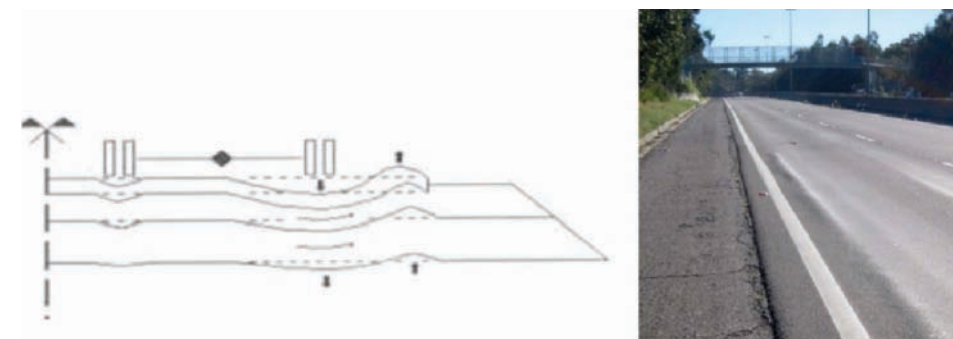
Mecanismo e foto de rodeiras com deformação plástica, em pavimento asfáltico
